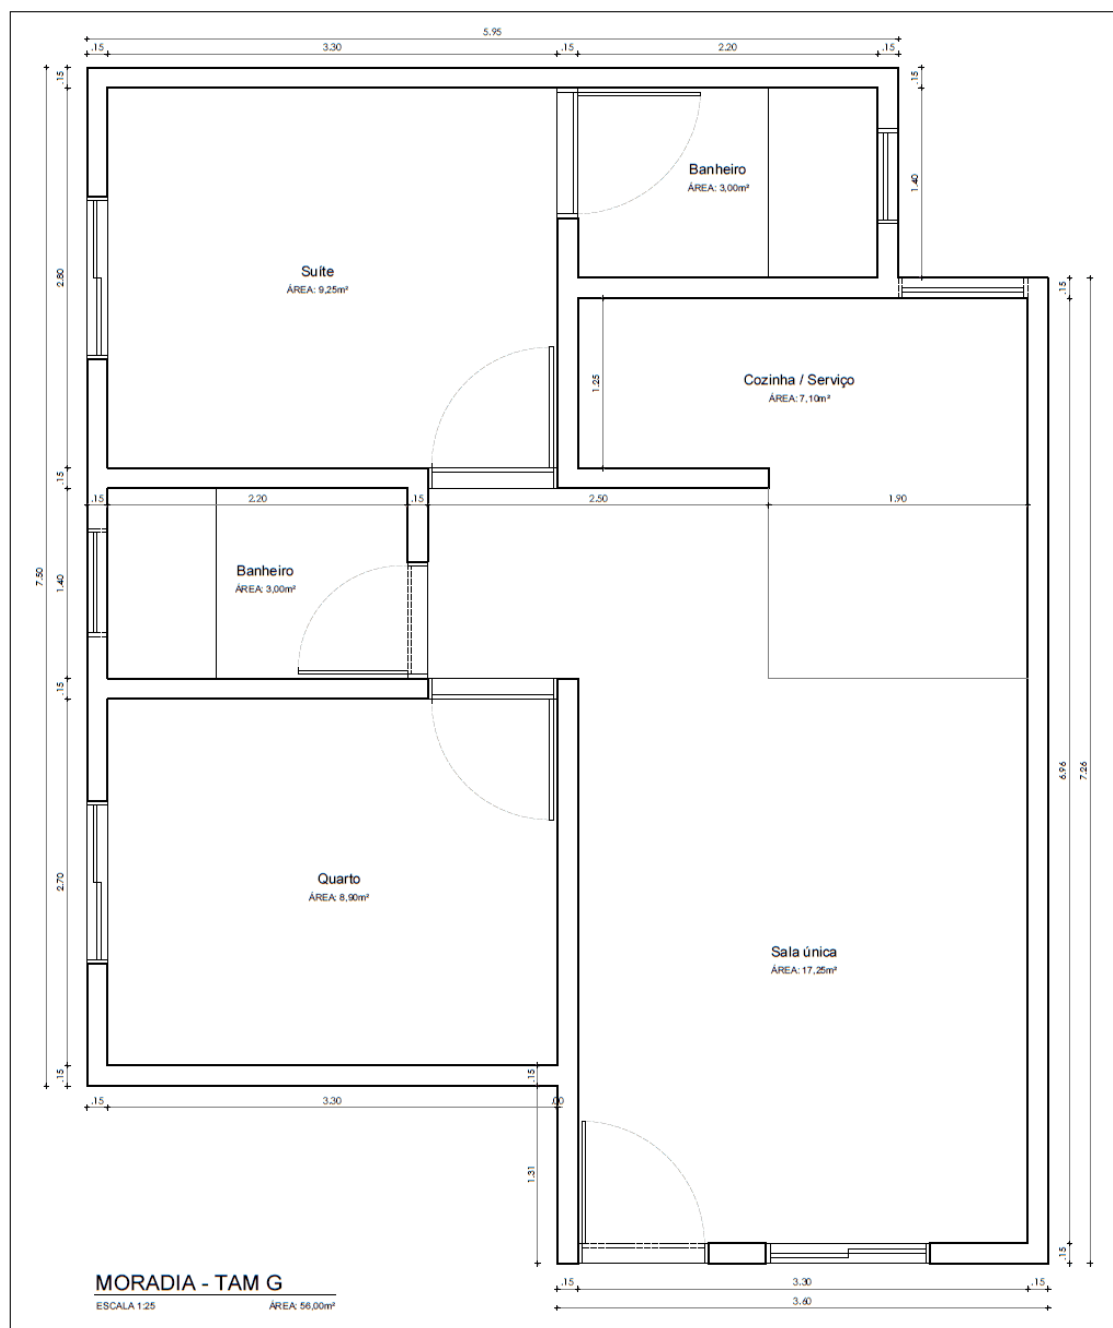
Imagem da planta do apartamento tamanho G (área: 56,00m²) utilizado na oficina.
